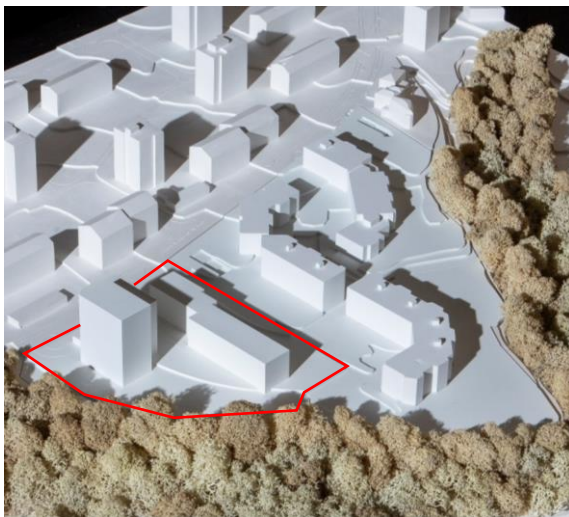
Modellfoto Bebauungskonzept (nach Realisierung des Quartierplans Schneckenbündten II)
